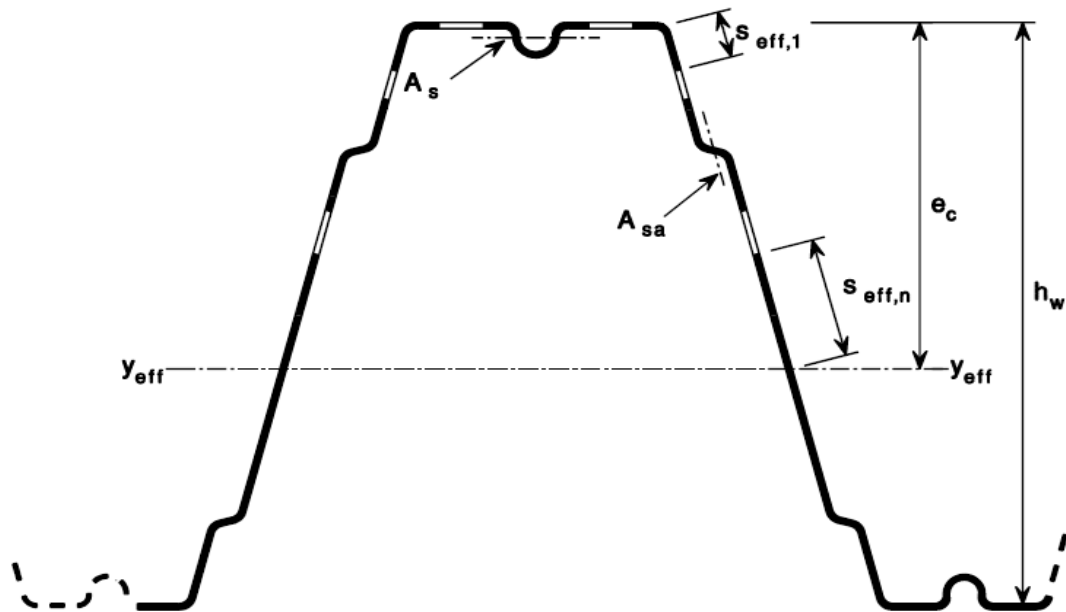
Lamiera con profilo geometrico trapezoidale con flange ed anime irrigidite
